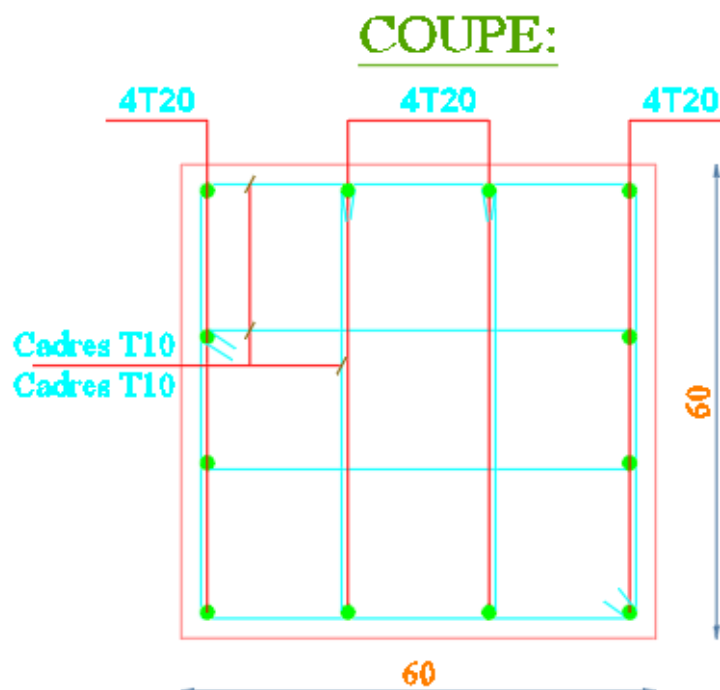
Schéma du ferrailage du poteau (60x60) cm²
